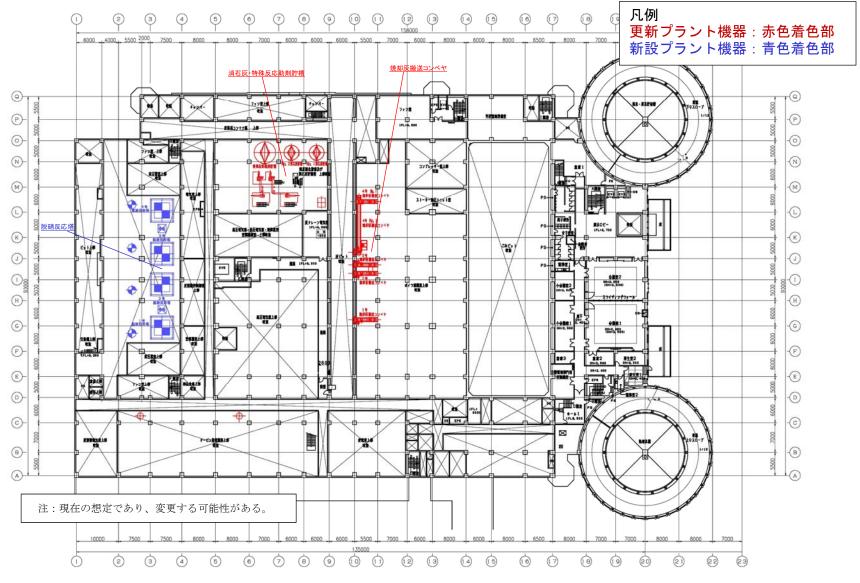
(3) 設備機器の更新箇所(3階平面図)
